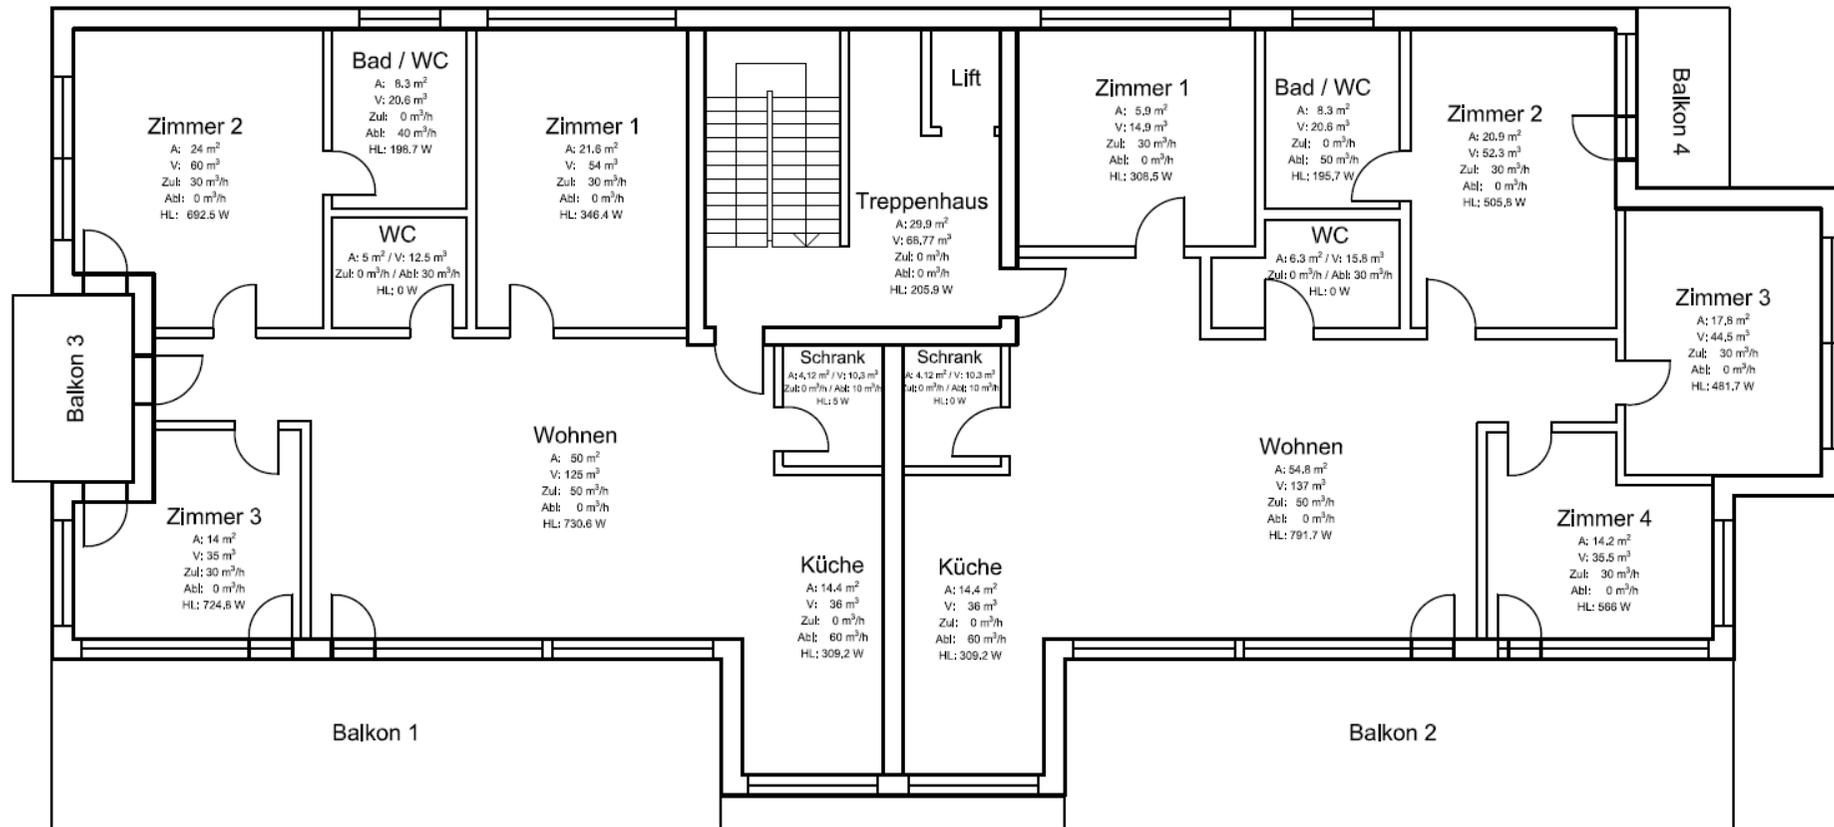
Grundriss des Zwischengeschosses mit Heizleistung nach SIA 384.201.
